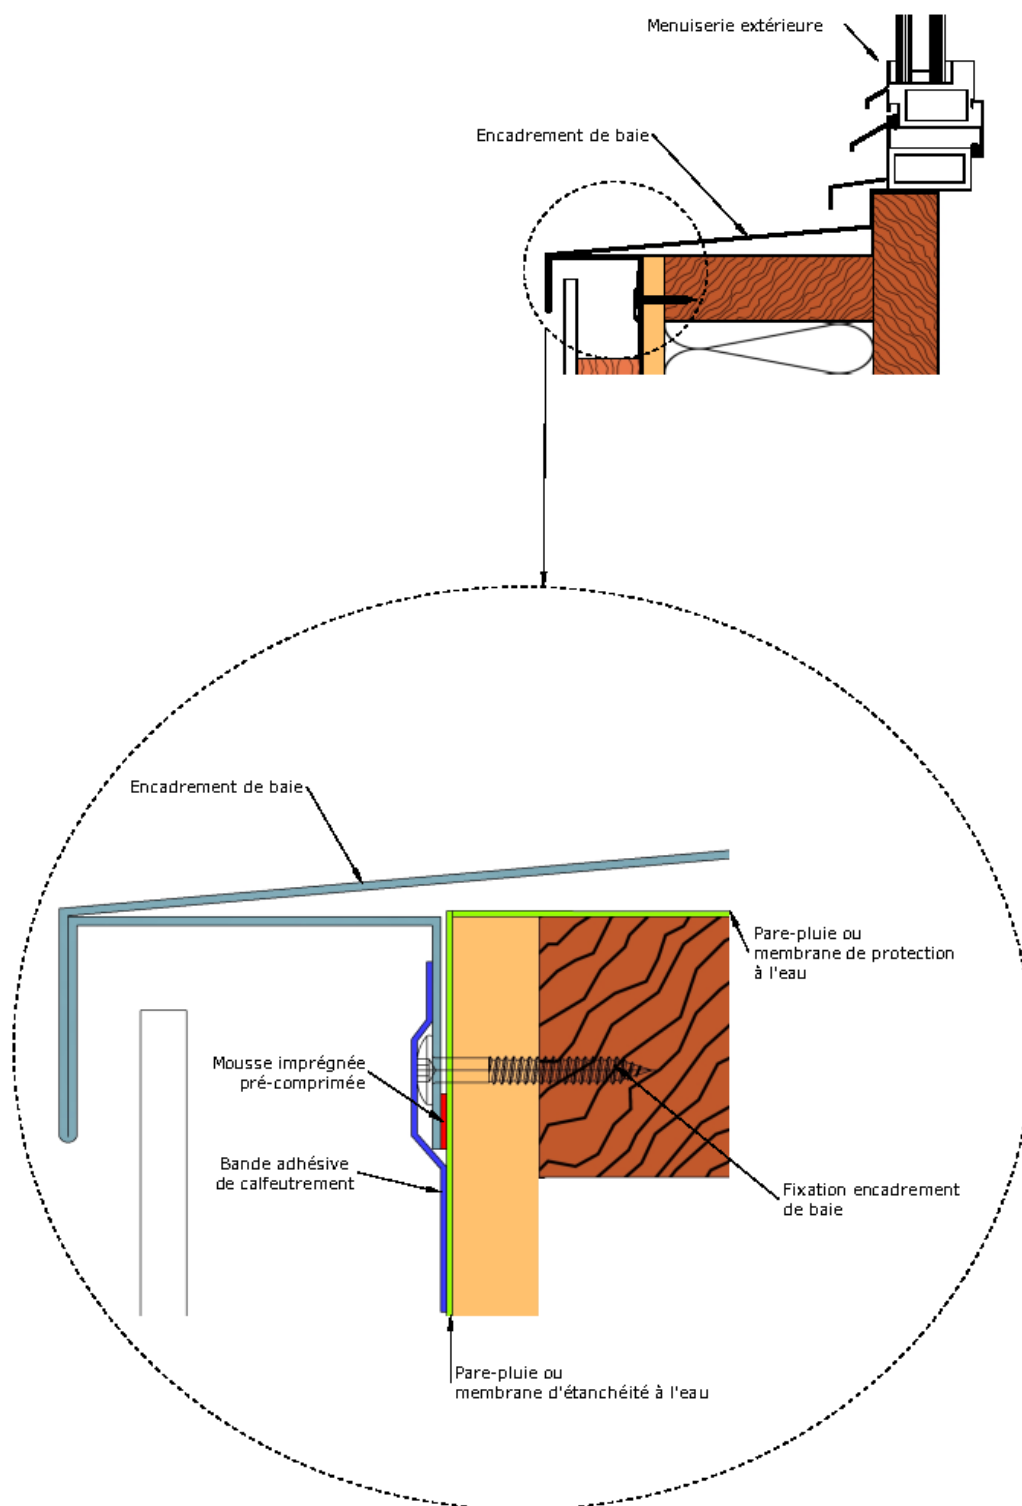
Liaison pare-pluie ou membrane de protection à l'eau avec encadrement de baie monobloc soudé 4 cotés acier 15/10e, Ee2, coupe verticale appuis
